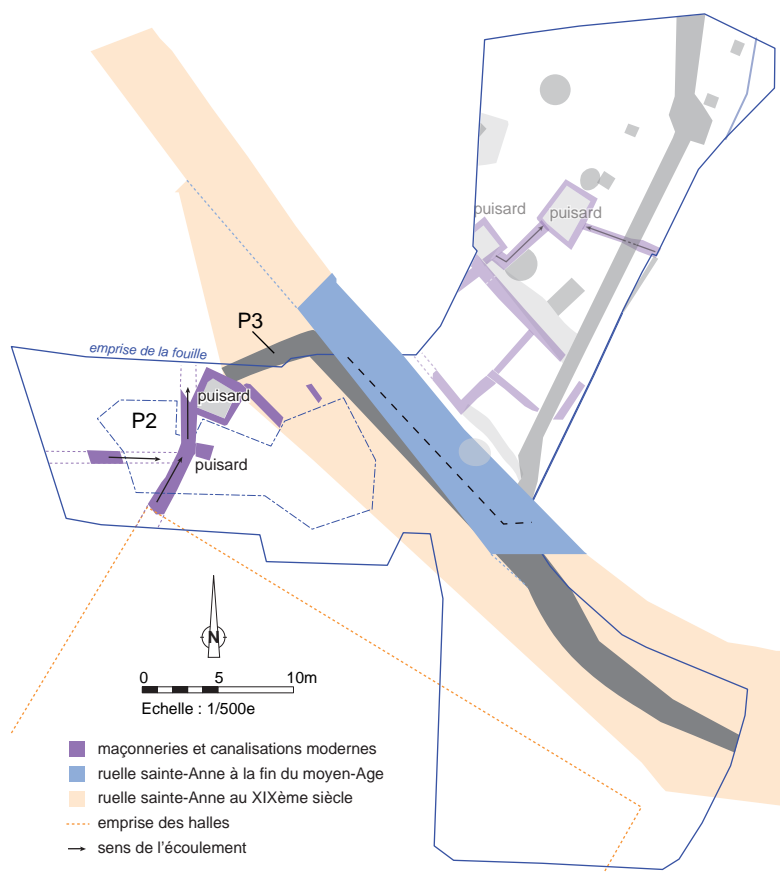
Plan des installations tout-à-l'égout de la fin de l'époque moderne en secteur 2 © Arnaud Desfonds, Inrap
